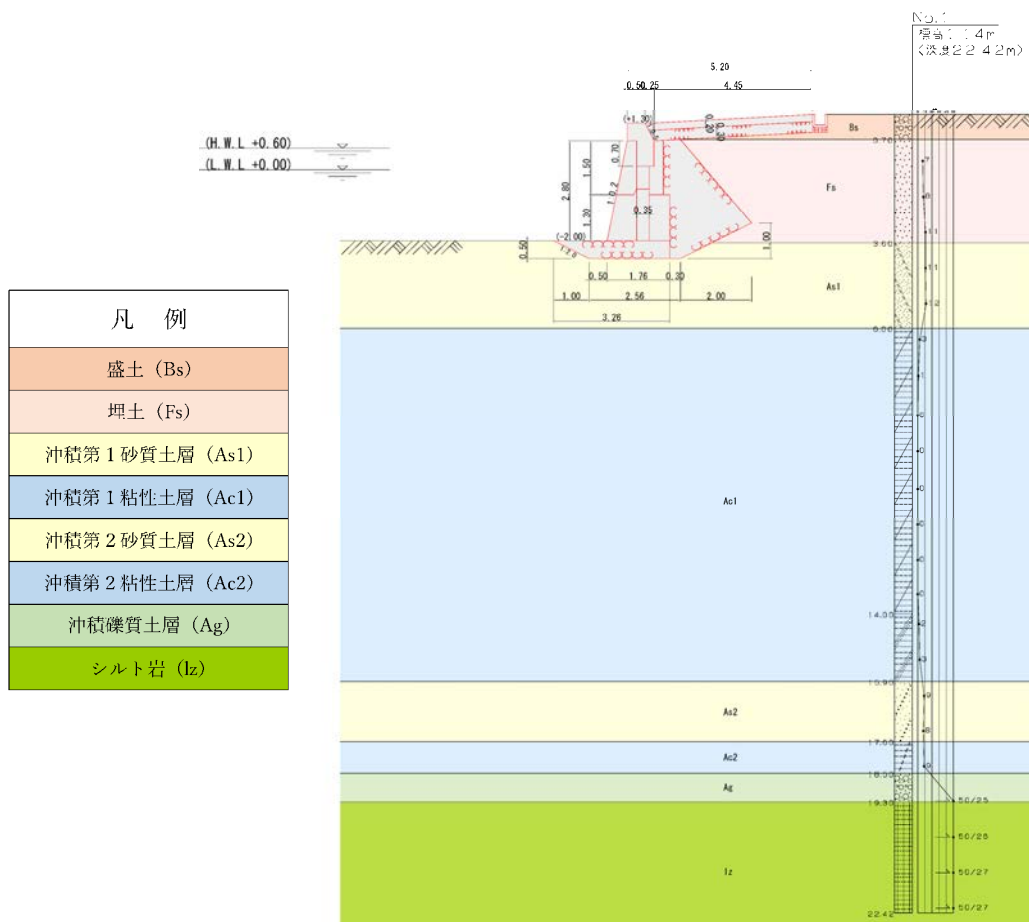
鵜飼漁港平面図及び断面図(※鵜飼漁港施設台帳)
